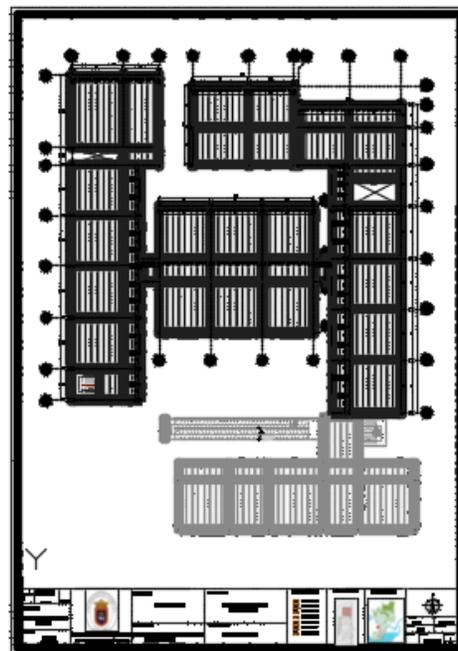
Esquema conceptual de Planta de entrepiso bloque académico 1 2 3
